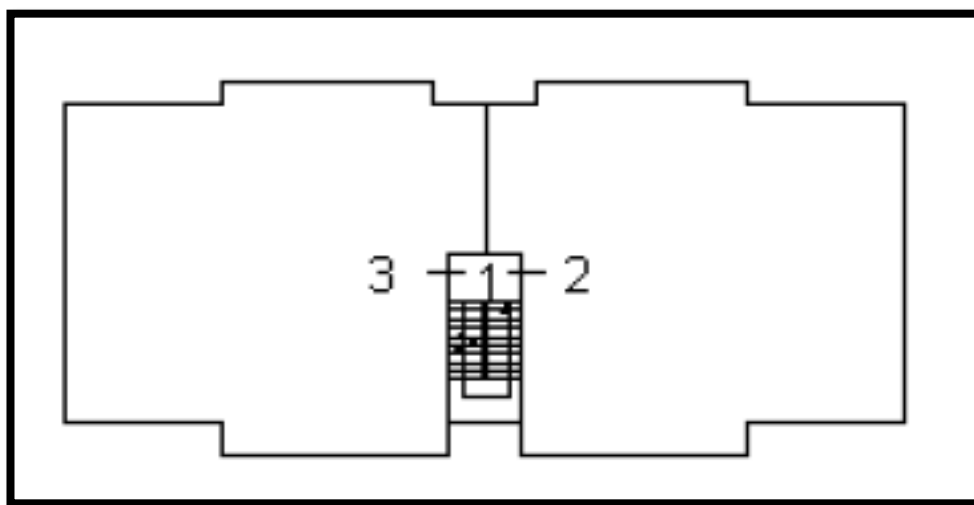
Elaborato planimetrico - Piano terra rialzato - Rappresentazione dell'ubicazione dei sub 2 e 3
